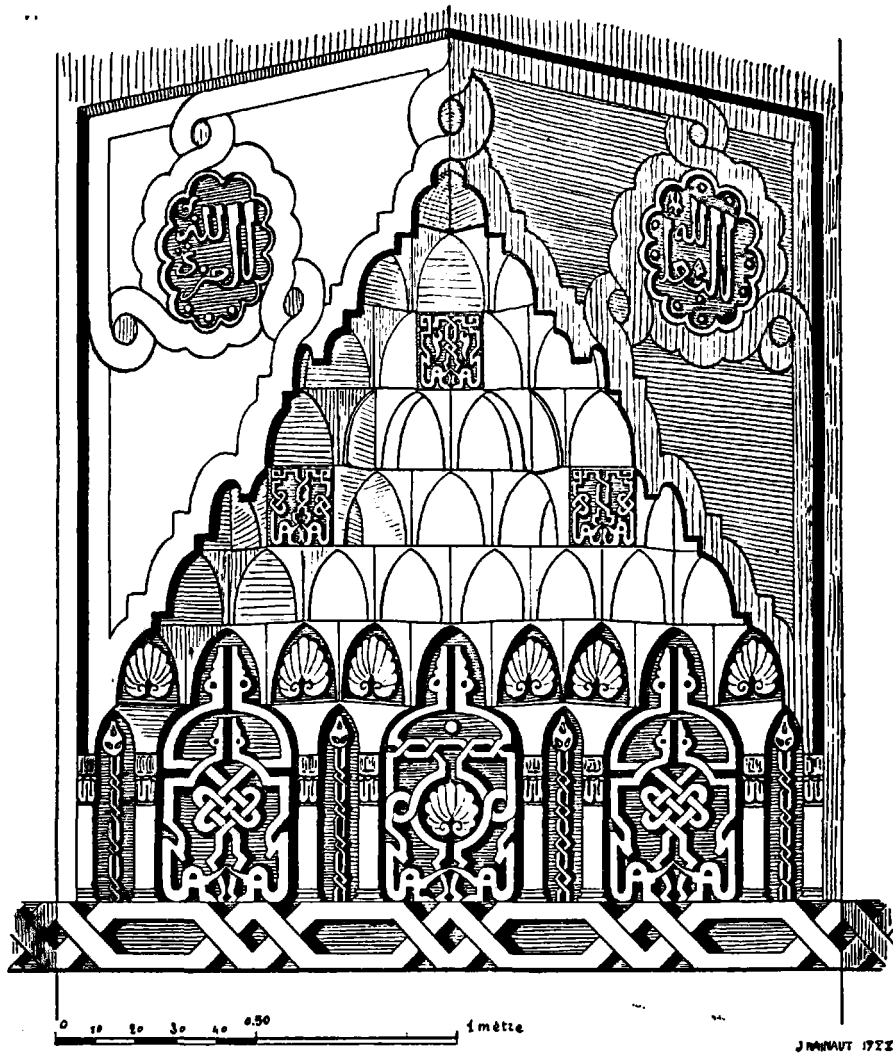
et 13. — Encorbellement à stalactites des tours. Élévation et plan.
